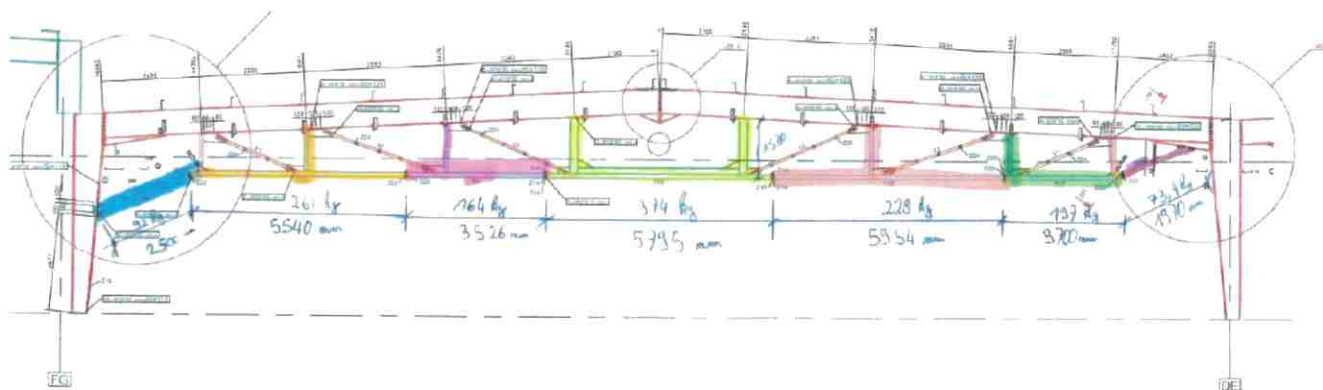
PLAN D'ELEVATION DETAILLE DE RENFORT D'UNE FERME DU BATIMENT
